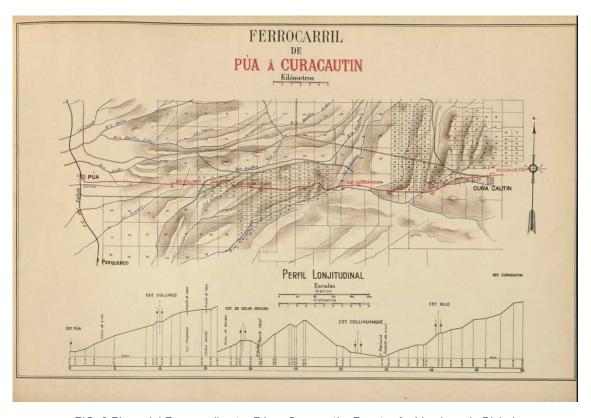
Plano del Ferrocarril entre Púa y Curacautín. Fuente: Archivo Ignacio Bisbal.
